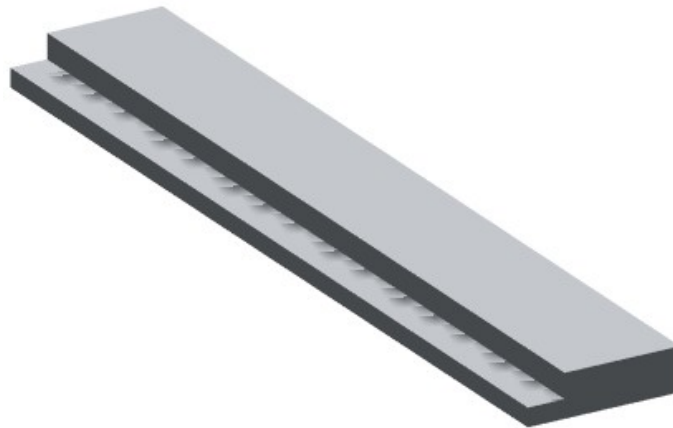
Isometri Model *Redesign Half Slab* Tipe – 1A
